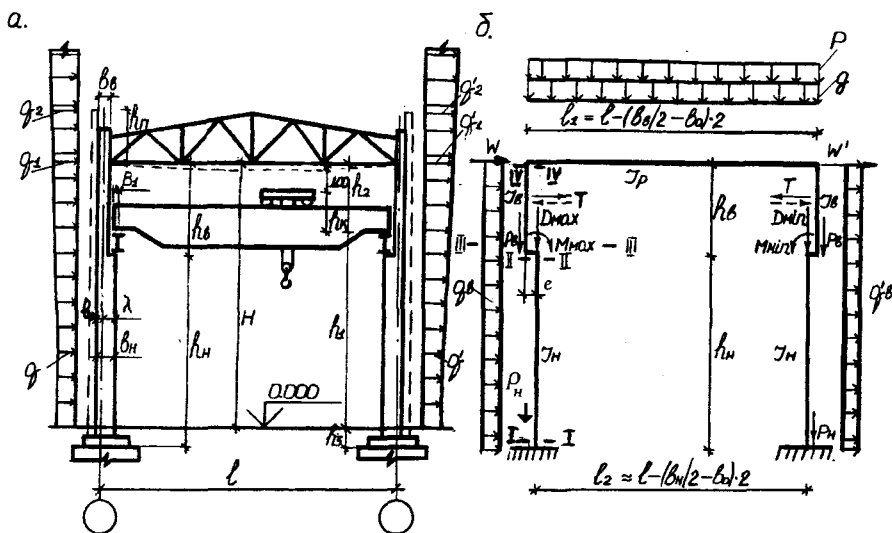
Поперечный разрез здания (а) и соответствующая ему расчетная схема (б)
